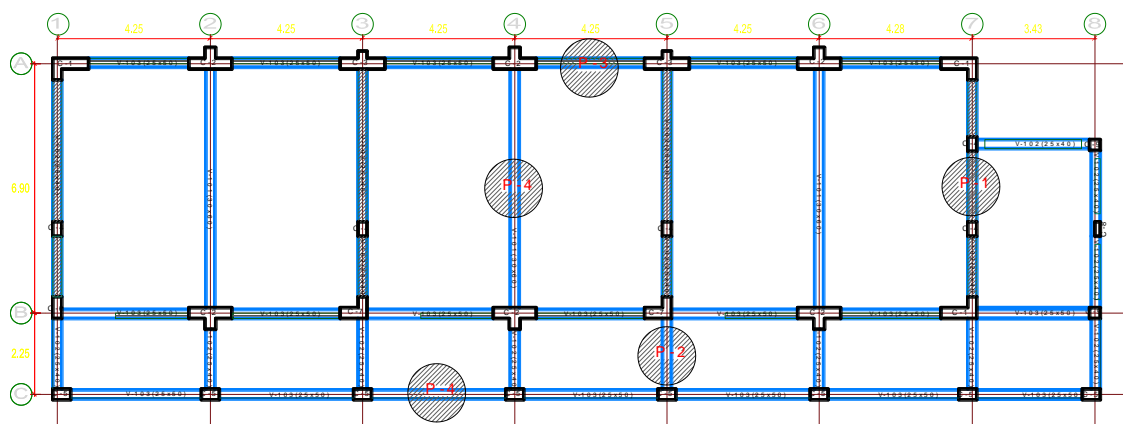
Ubicación de la prueba de rebote para las Vigas.
